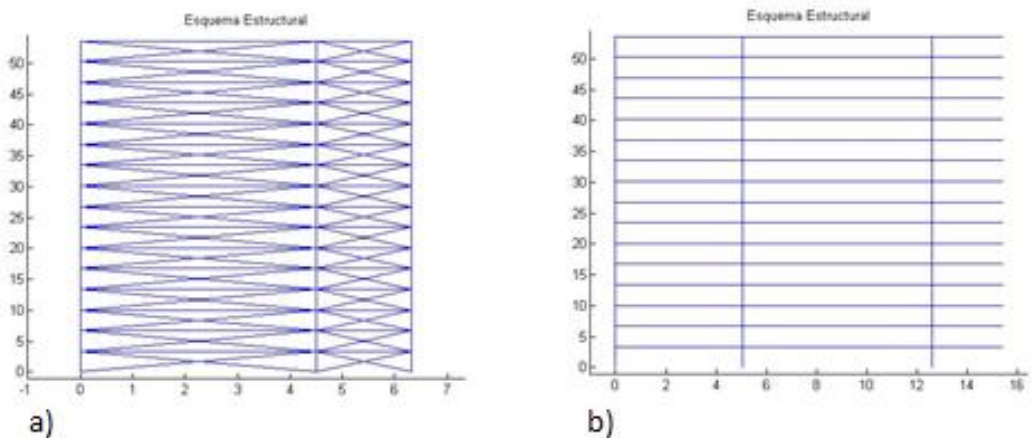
Pórticos transversales sin reforzamiento a) Pórtico 5'; b) Pórtico 5.
